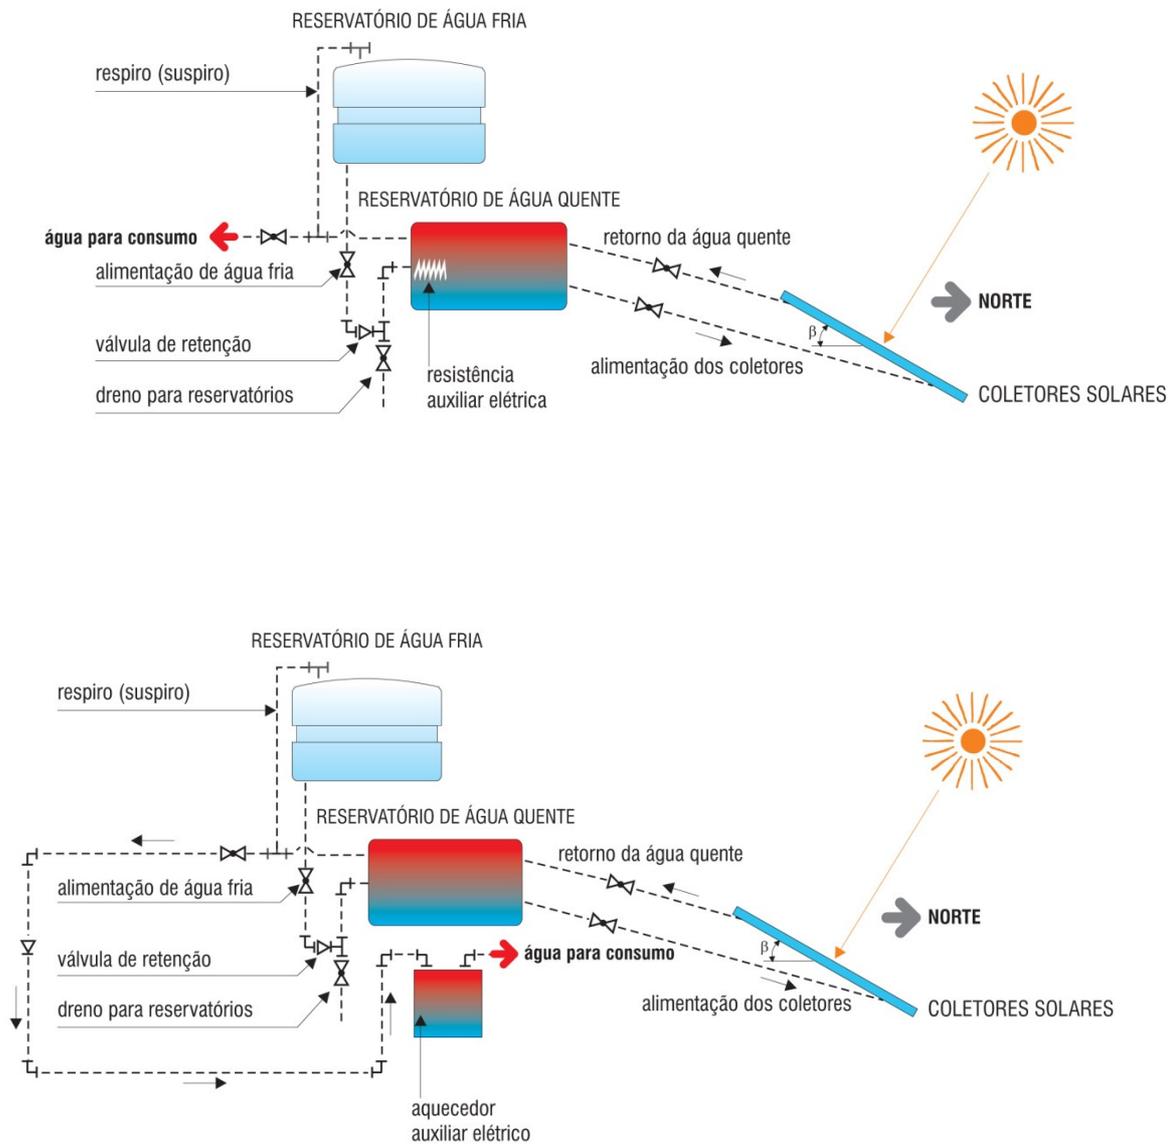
Sistema passivo direto para aquecimento de água.
